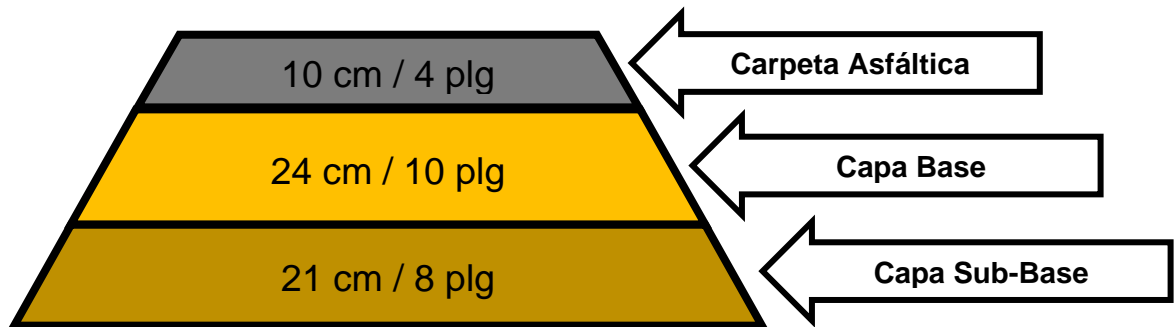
Espesores de la estructura del pavimento KM 07+000 hasta 14+000
